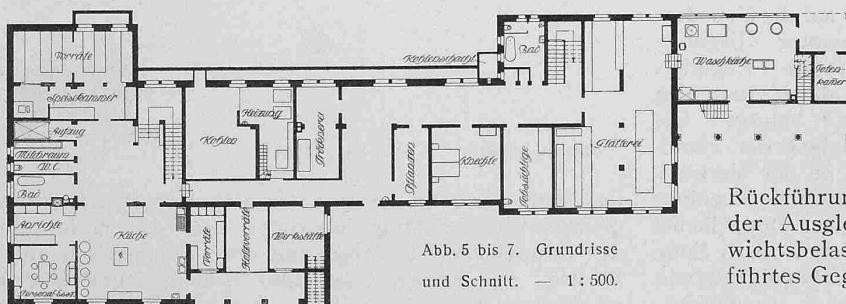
bis 7. Grundrisse und Schnitt. — 1:500.
